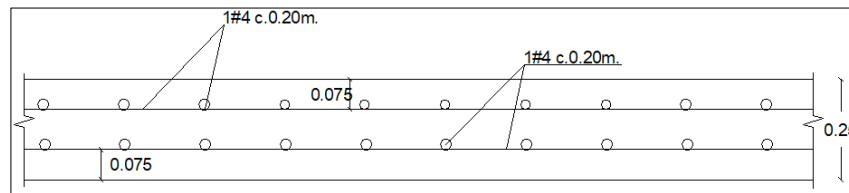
Detalle losa del fondo del tanque (losa de cimentacion).
